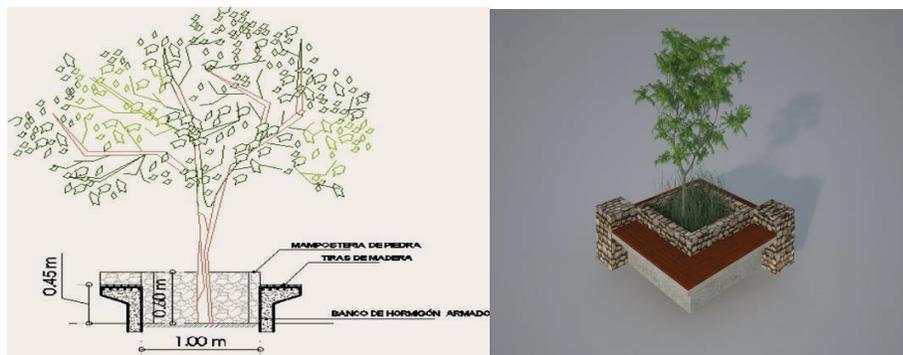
Detalle constructivo jardinera y banca; Propuesta en 3D
